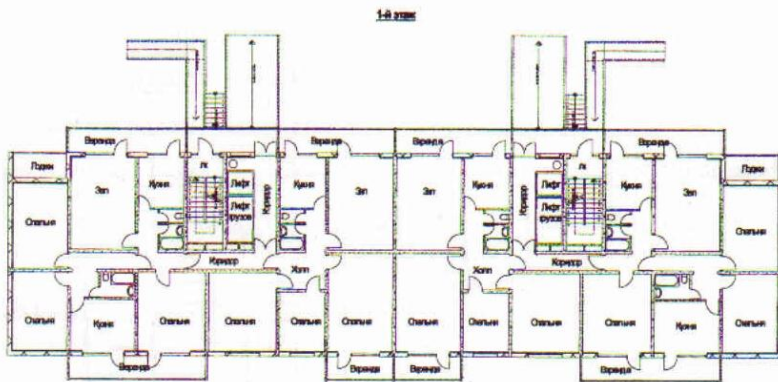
Двухсекционный жилой дом (4-5)+(4-5) комнатными квартирами. План 1-го этажа
